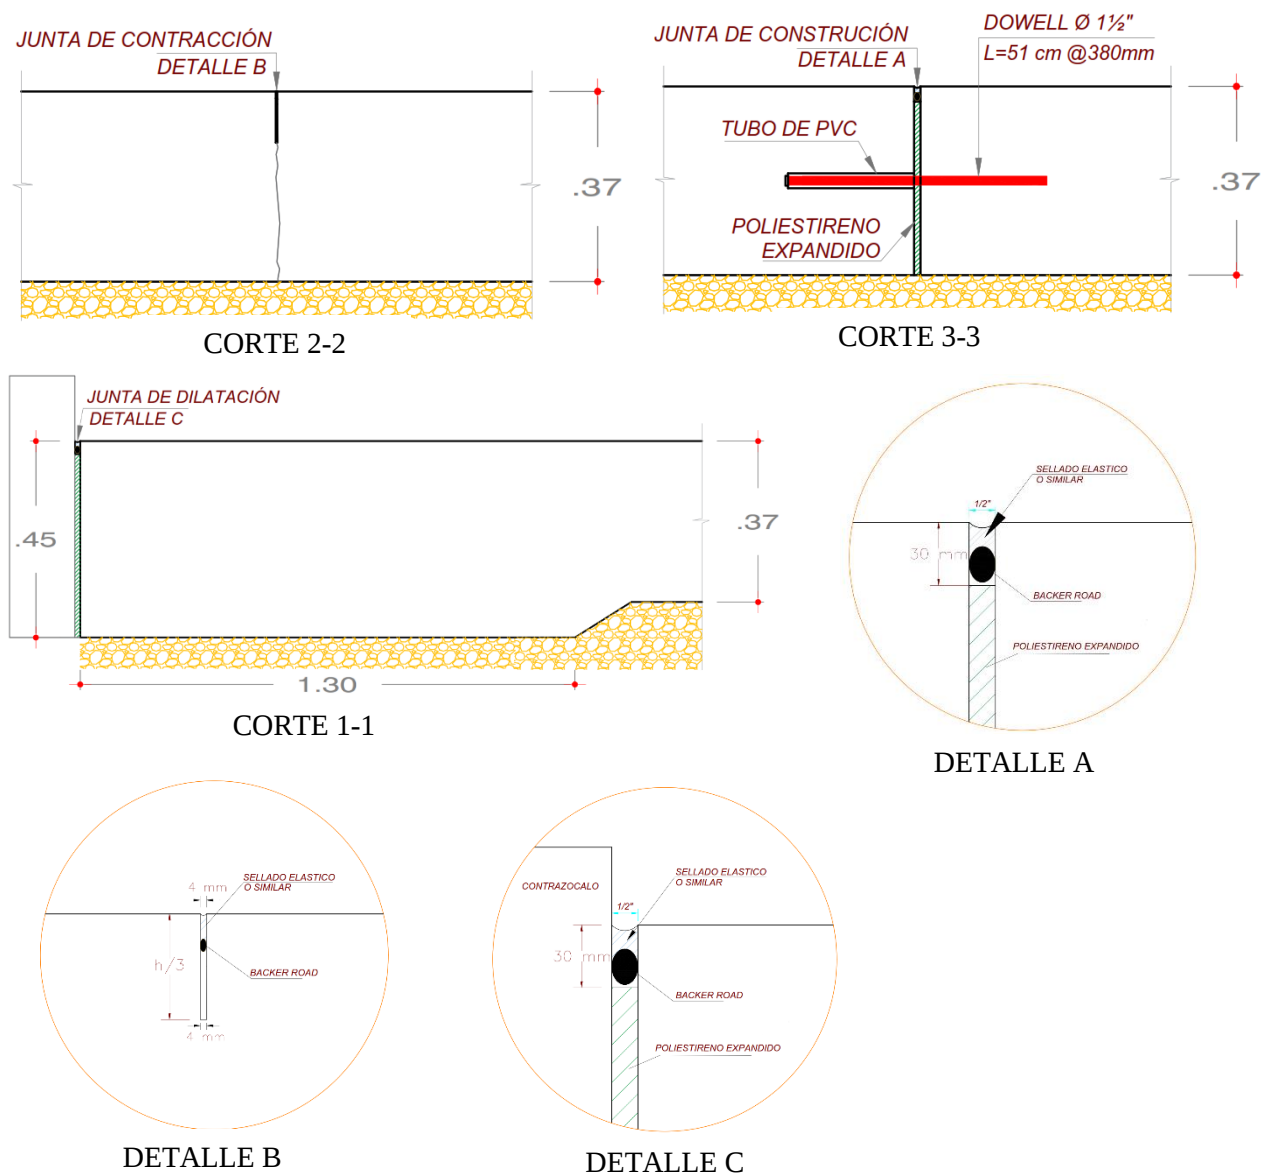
Detalles del corte de losa para la mezcla del concreto patrón (CP).
